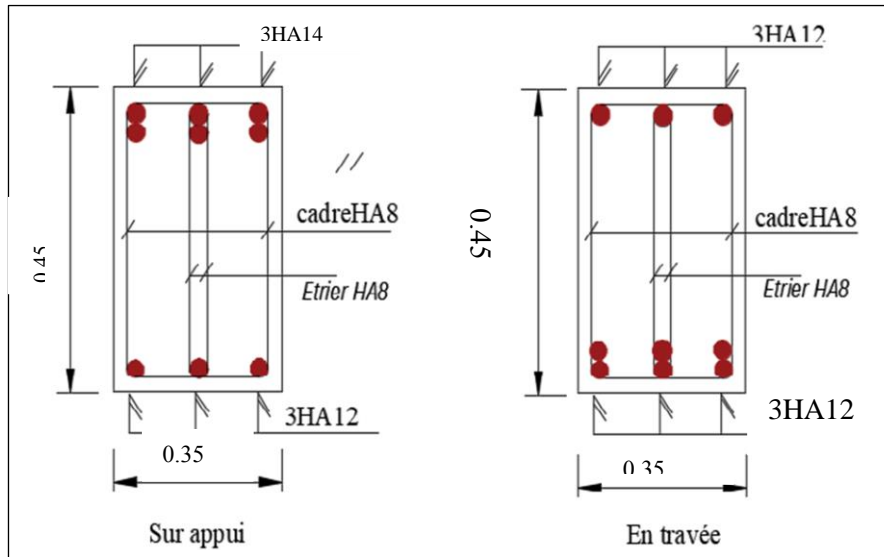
Schèmes de ferrailage des poutres principales.
